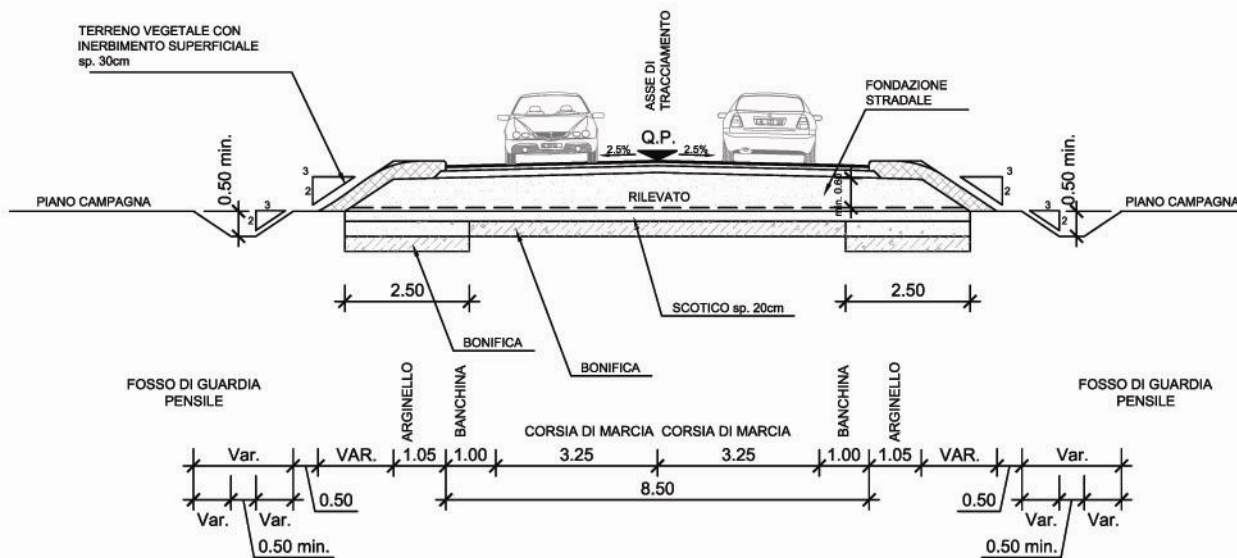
ESEMPIO DI SEZIONE TIPO F LOCALE IN RETTIFILO
